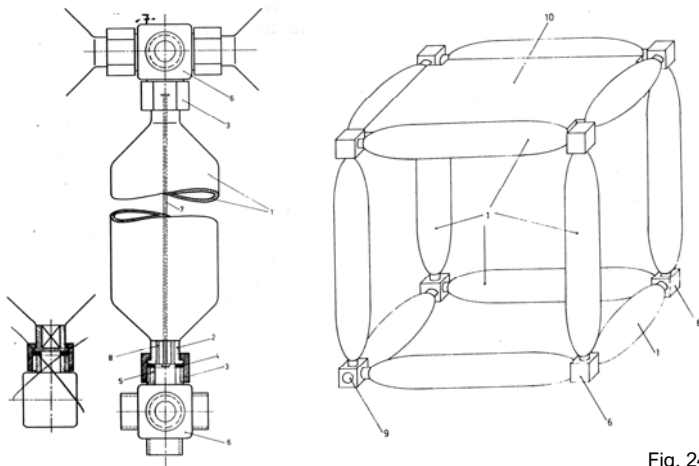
Willy Herold. Celosía espacial con elementos estructurales no rígidos. *Raumgitterwerk mit nicht starren Bauelementen*, patente DE1659121, 1968.
